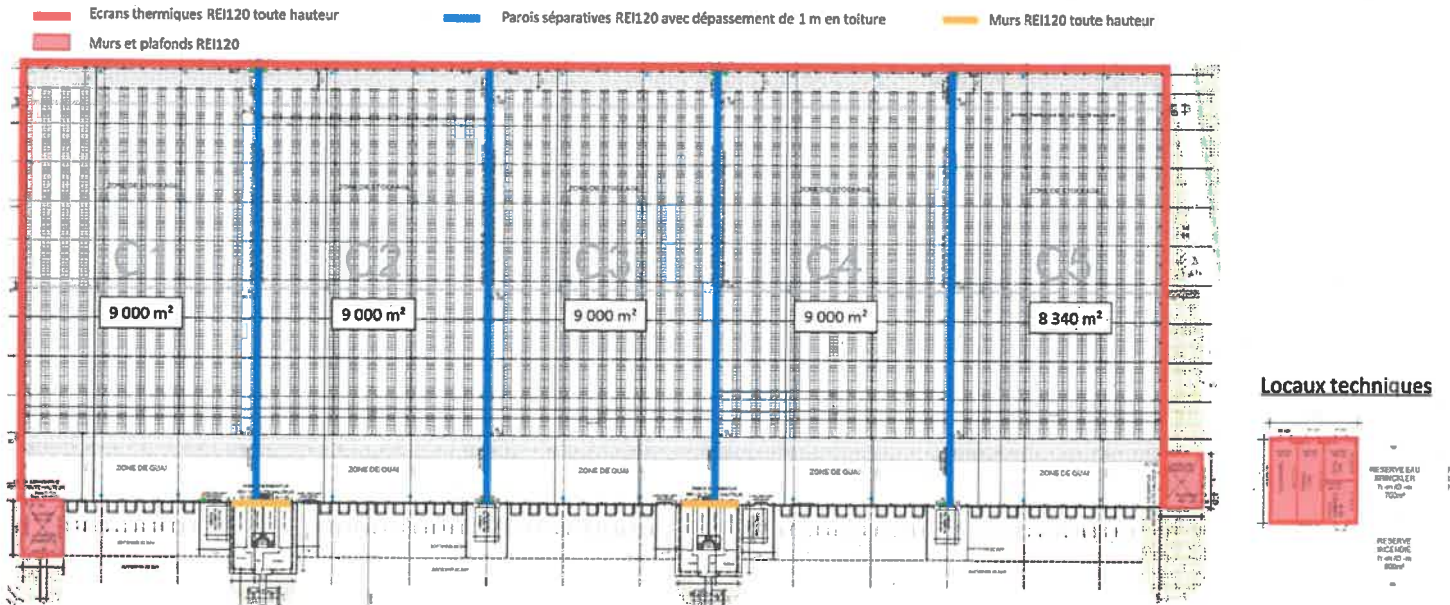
Plan des murs coupe-feu de l'entrepôt
